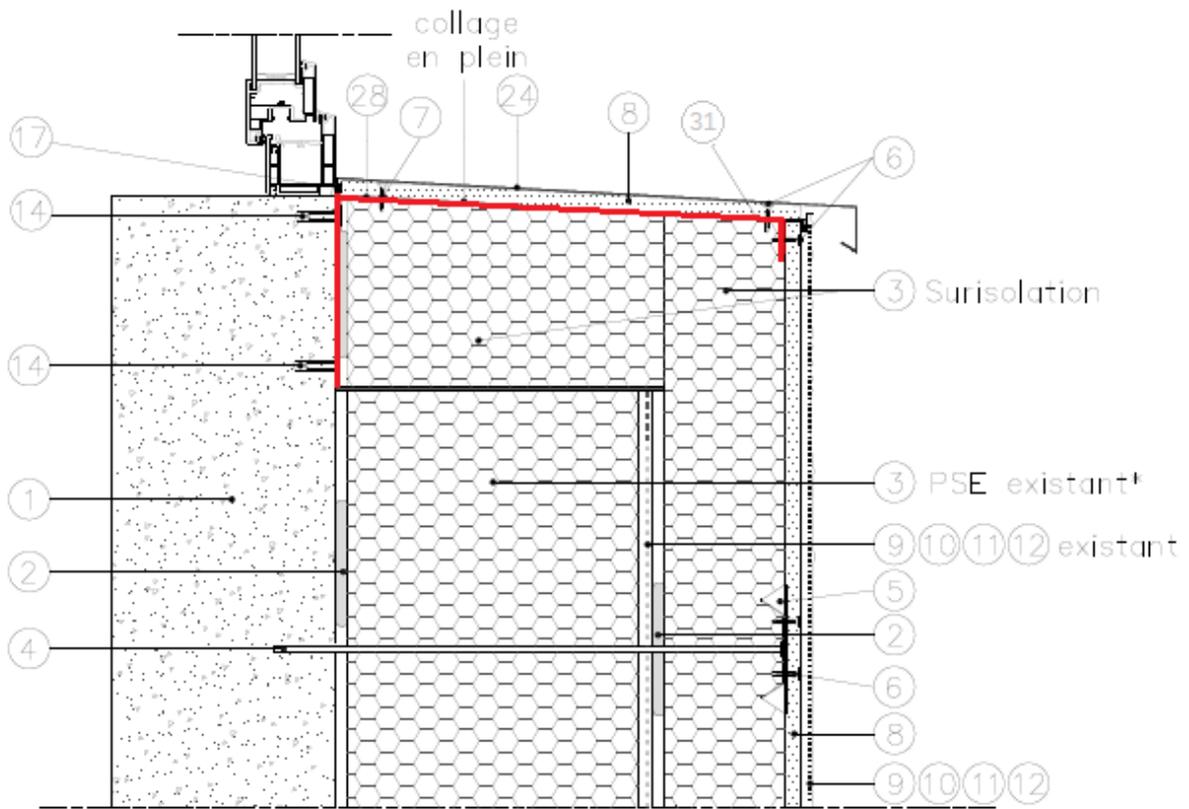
jonction latérale avec un système d'ITE - cas générique - coupe horizontale
